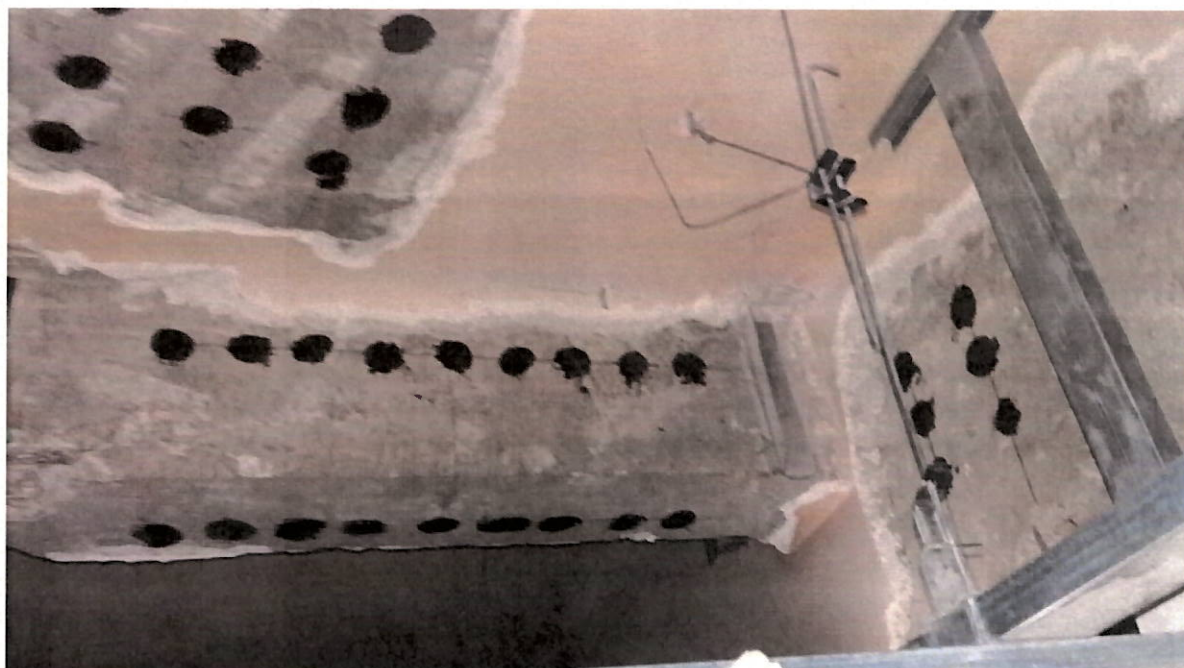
decopertare pentru determinari nedistructive – planseu peste parter, zona atelier
